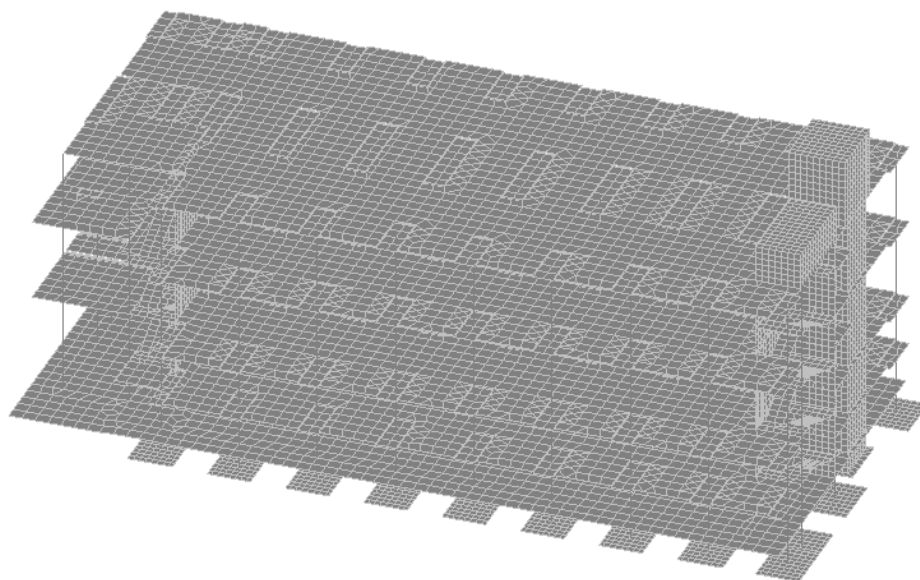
Расчетная схема каркаса здания с фундаментом мелкого
